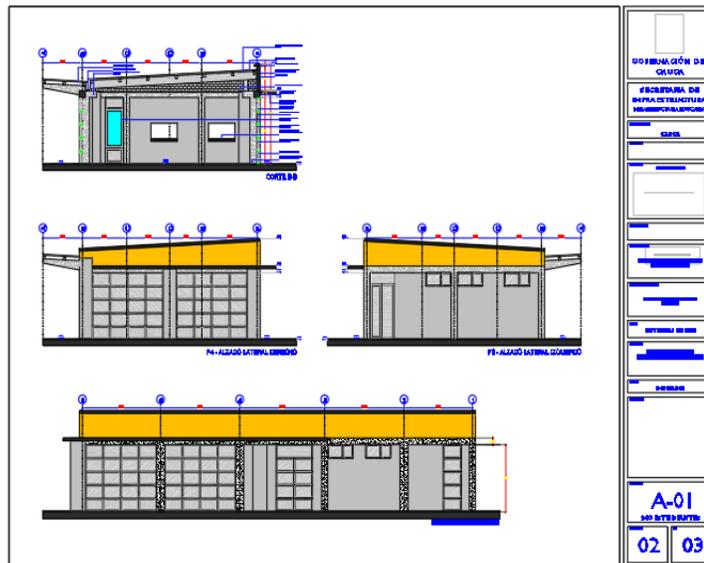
Planos arquitectónicos Restaurantes Escolares. Fuente: Arq. Juan Serrano
